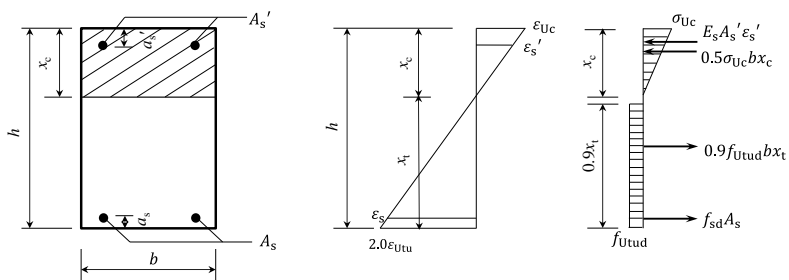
配置纵向普通钢筋的矩形截面超高性能混凝土受弯构件正截面承载力计算
